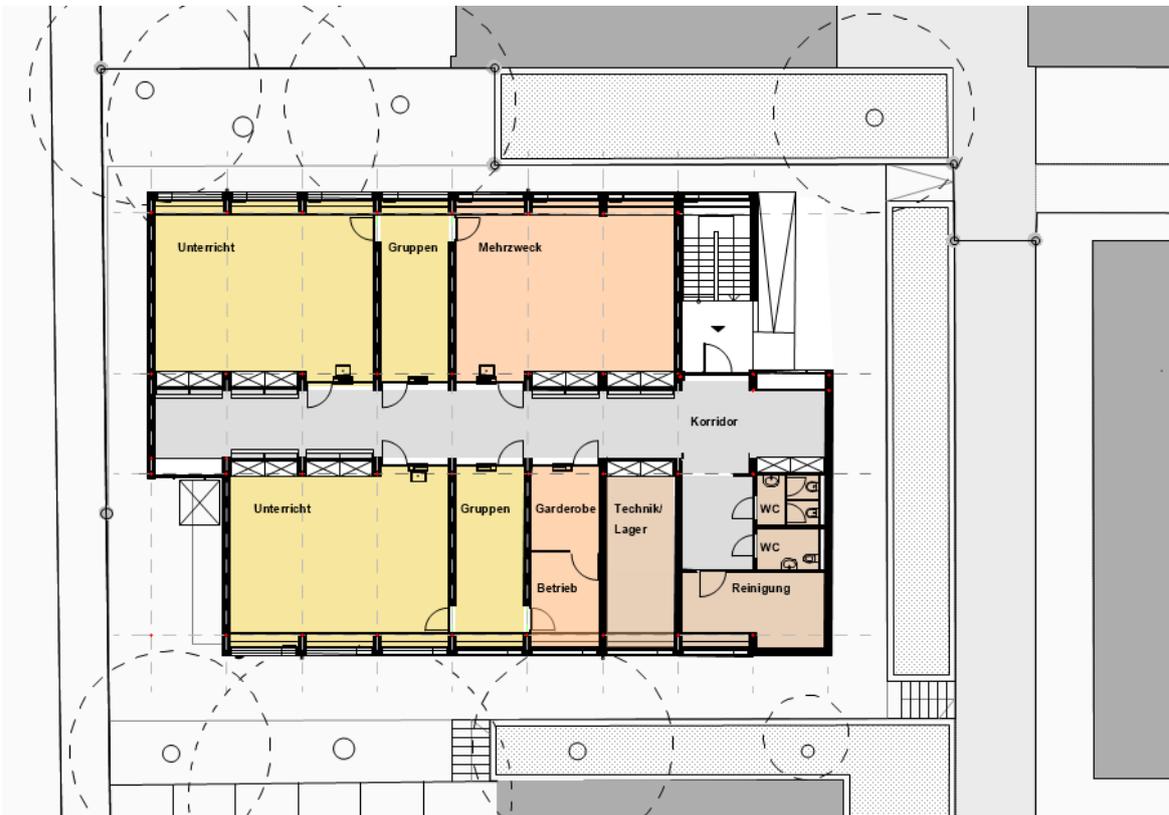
Grundriss Provisorium Steigerhubel (Stand Machbarkeitsstudie)
